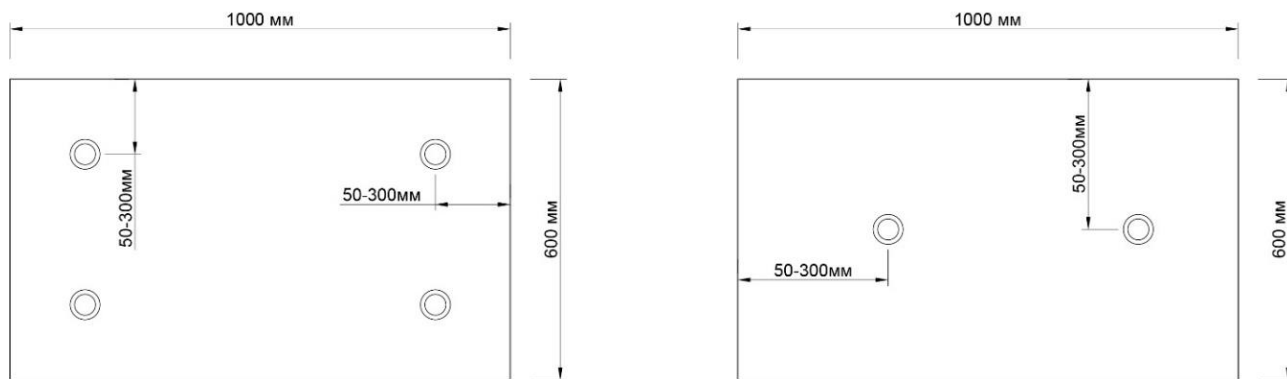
Схема крепления теплоизоляционных плит из минеральной ваты.
